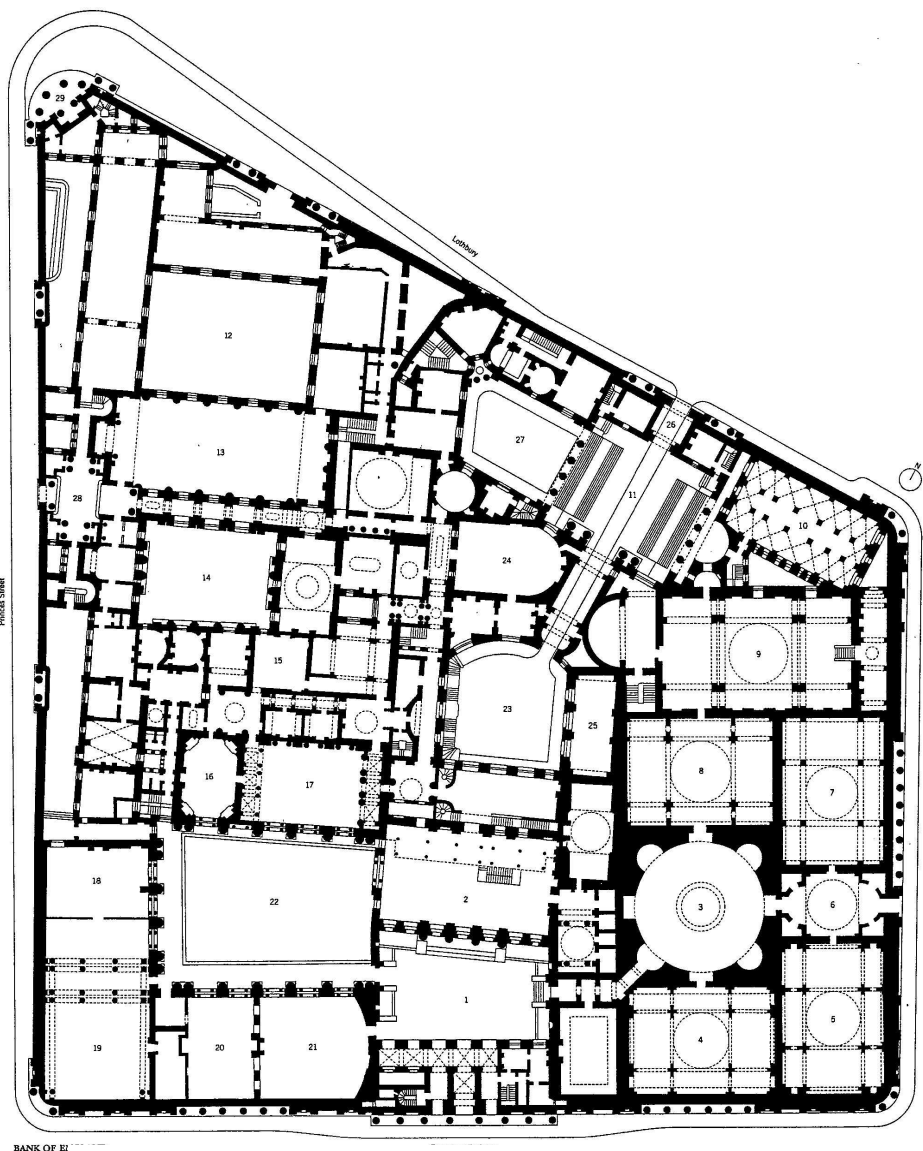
Planta del Banco de Inglaterra en Londres (John Soane).
